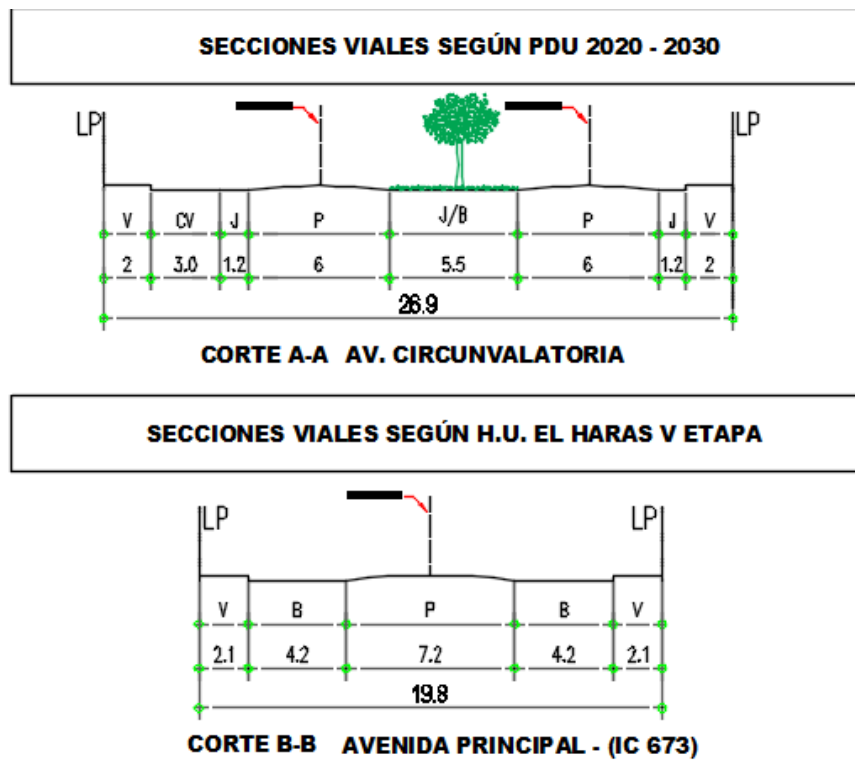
Secciones de vías existentes. ver plano PI - 15
